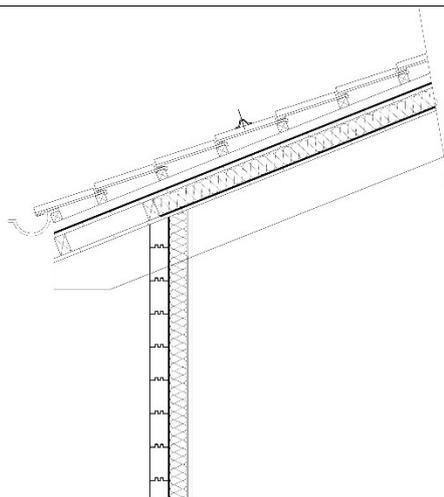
Soluzione per il collegamento tra pareti e copertura per un edificio Log House con pareti continue.
